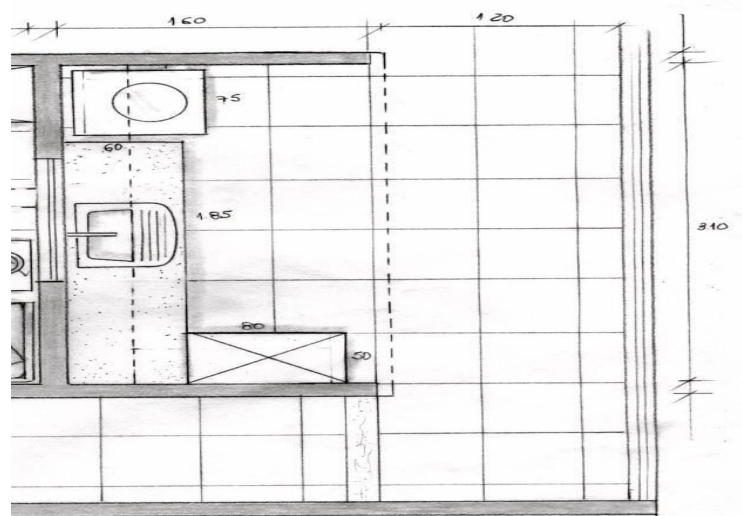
Planta baixa área de serviço. Fonte: NUNES, 2016
